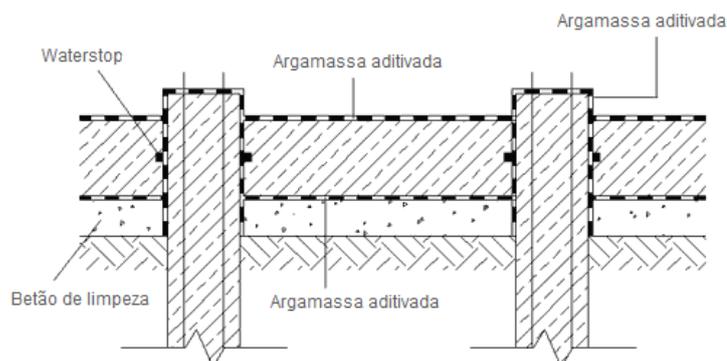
Impermeabilização de um maciço de encabeçamento com argamassa aditivada (Safeguard@ 2014)
